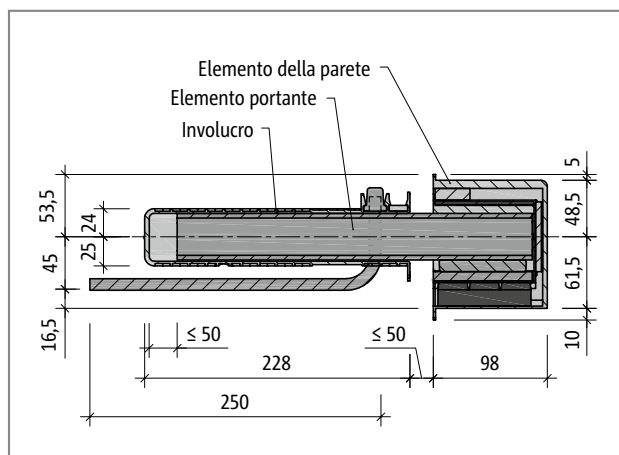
Schöck Tronsole® tipo Q, sezione dell'elemento A-A
